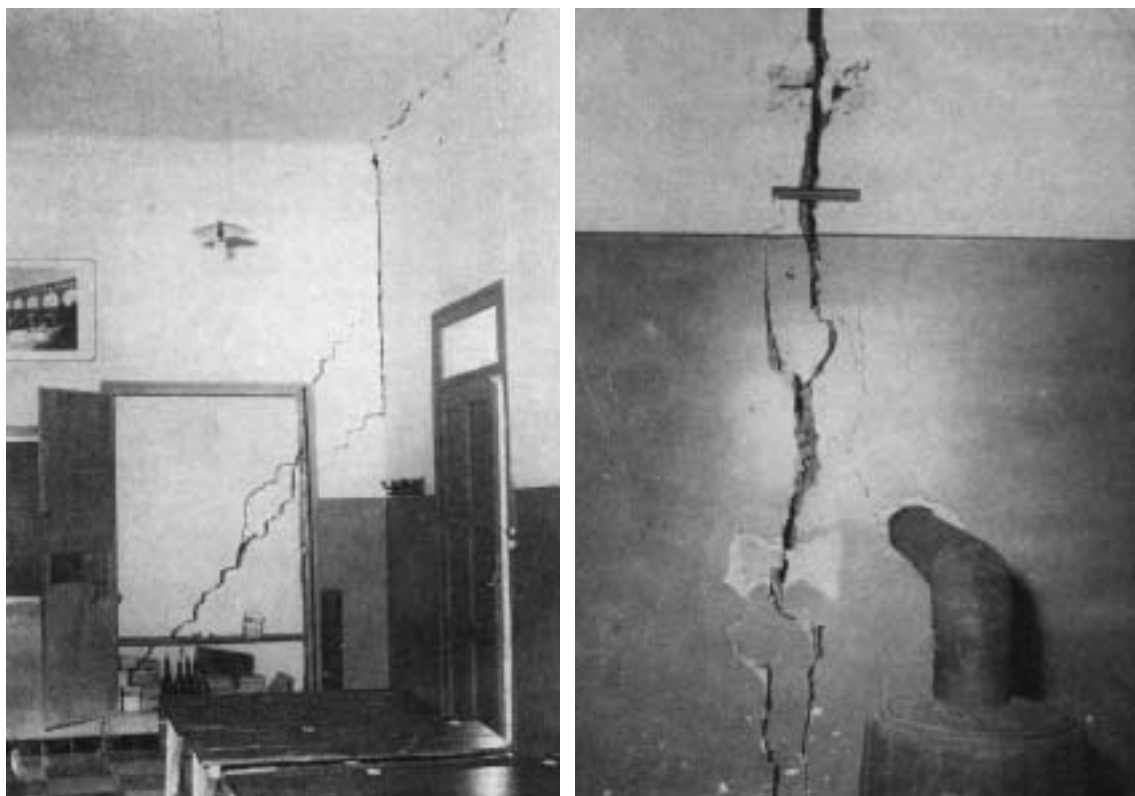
e 13 – Fissuras nas paredes de um grupo escolar fundado sobre um terreno argiloso e inclinado, sem nenhum dispositivo de evacuação das águas pluviais
